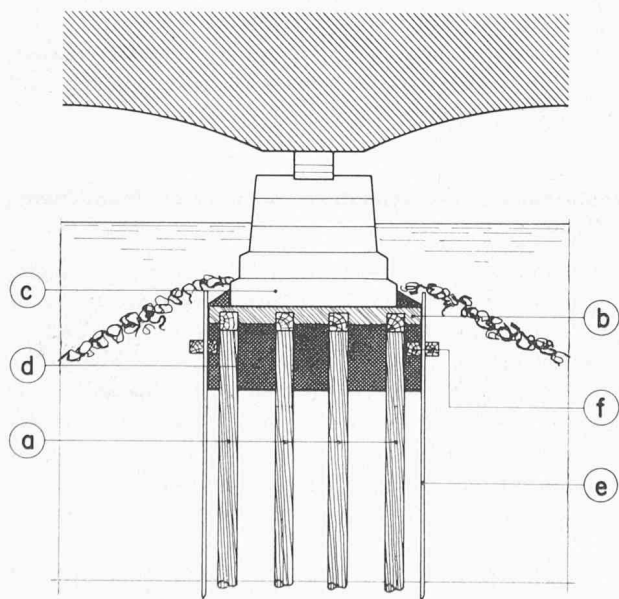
Coupe au travers d'une fondation avant son renforcement.
